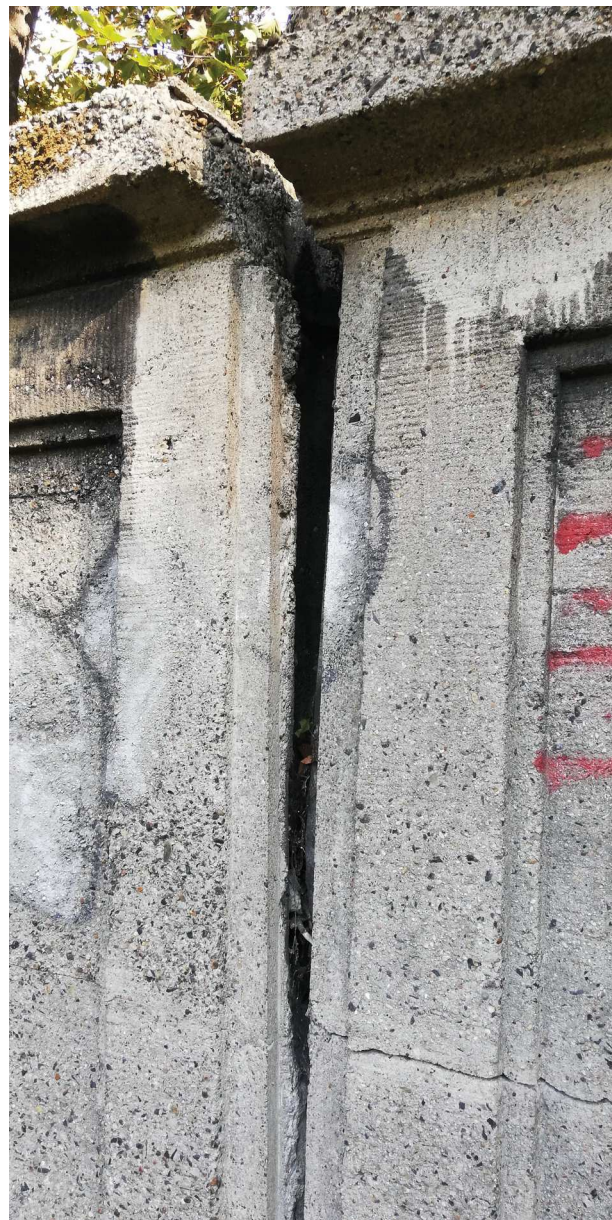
Widok uszkodzeń muru spowodowanych zapadnięciem się gruntu
